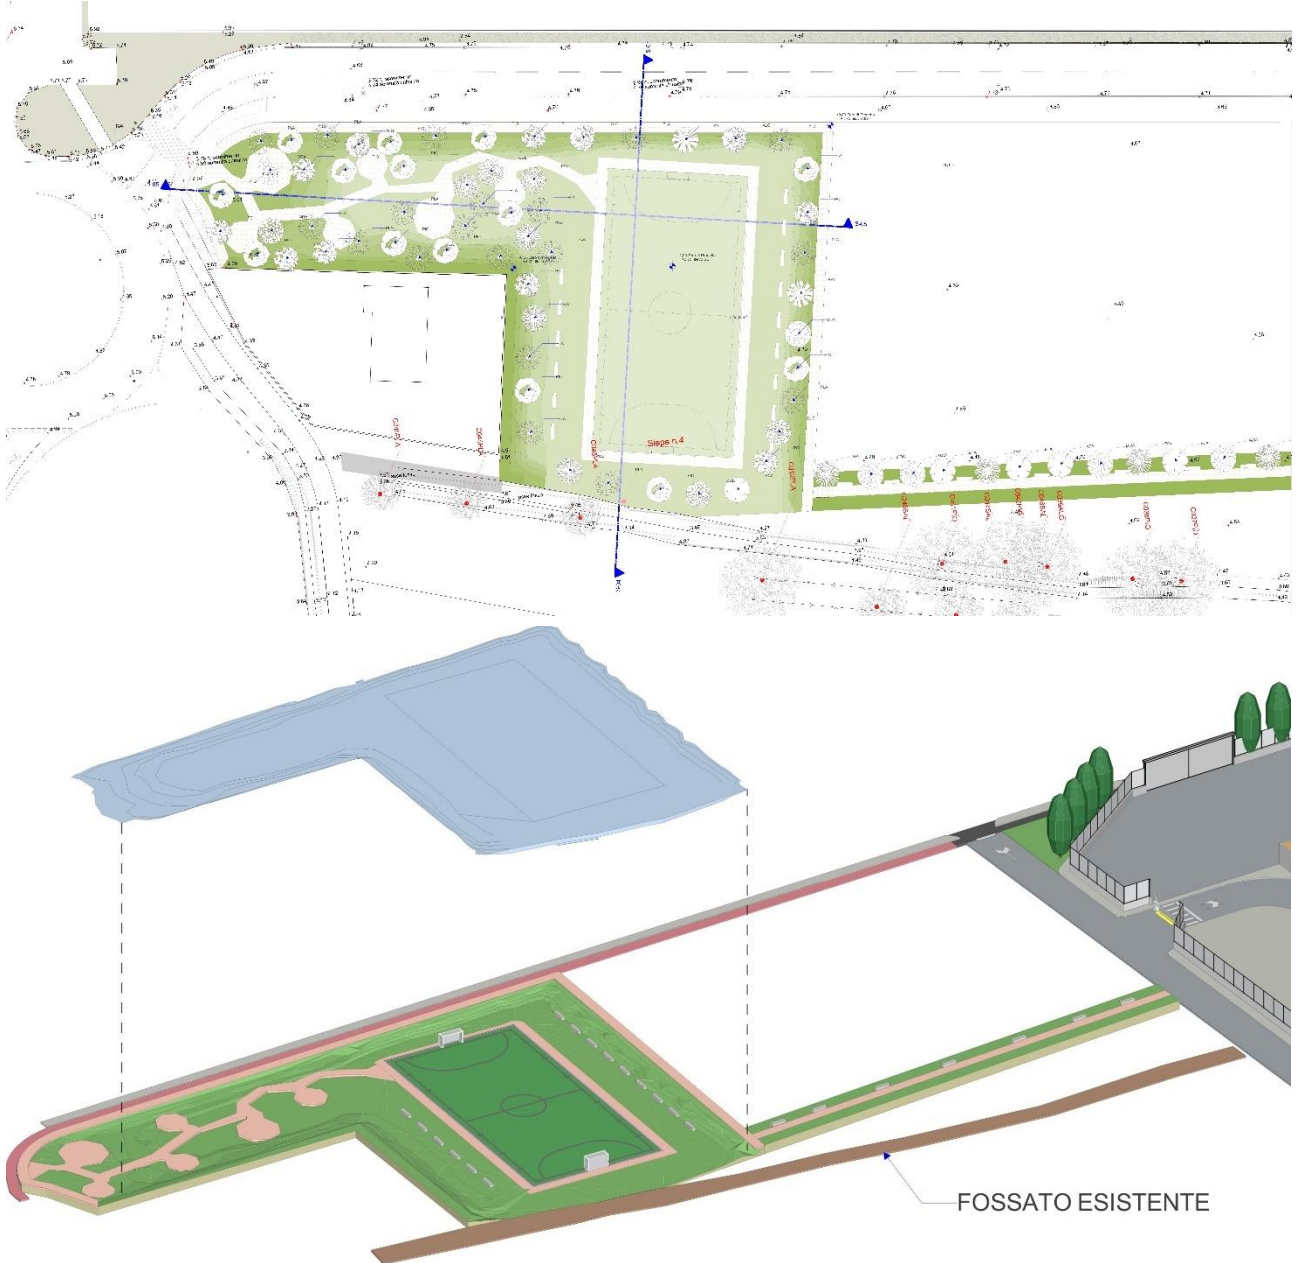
Rappresentazione planimetrica ed assonometrica della sistemazione a verde dell'area sud-ovest (Fonte: Stato di progetto – Verde Pubblico – AI Progetti)
